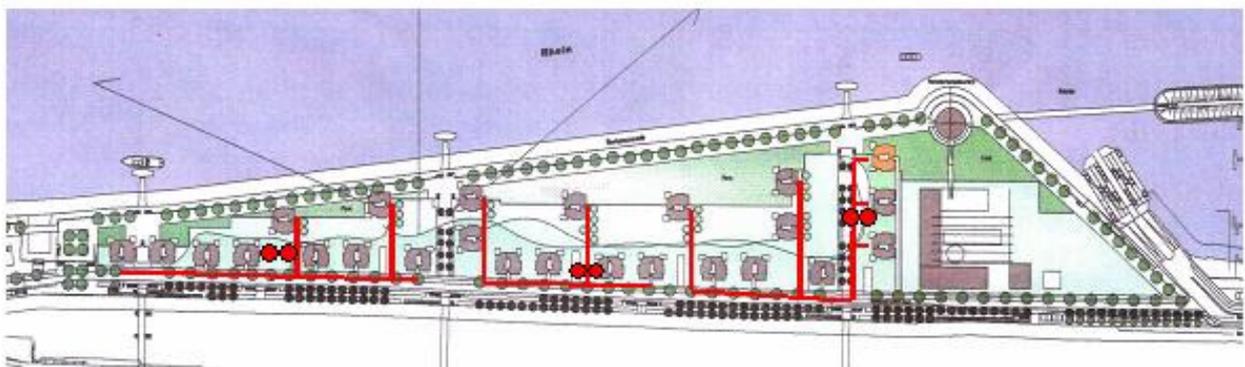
Lageplan mit Brunnen und Kalten Nahwärmenetzen
